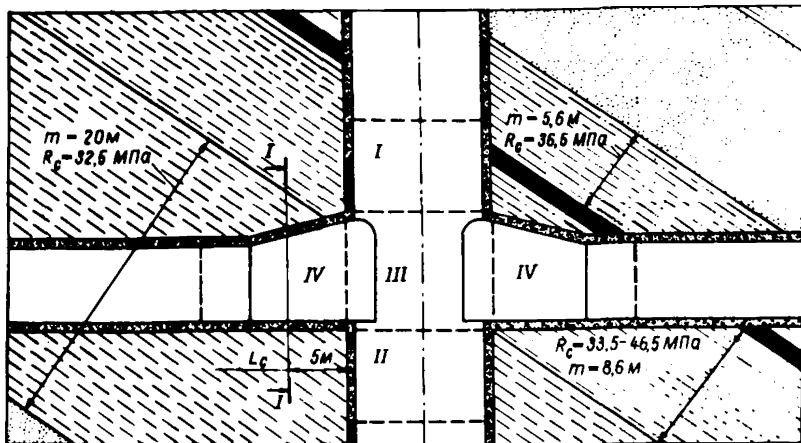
Схема к расчету нагрузок на крепь сопряжения в зоне 1У
